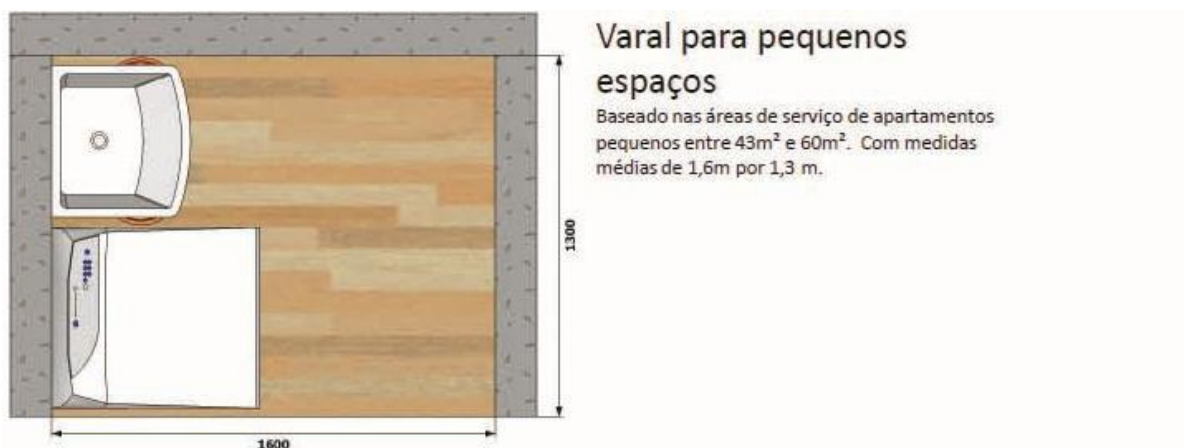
Planta baixa áreas de serviço - Apto 43 a 60m²
